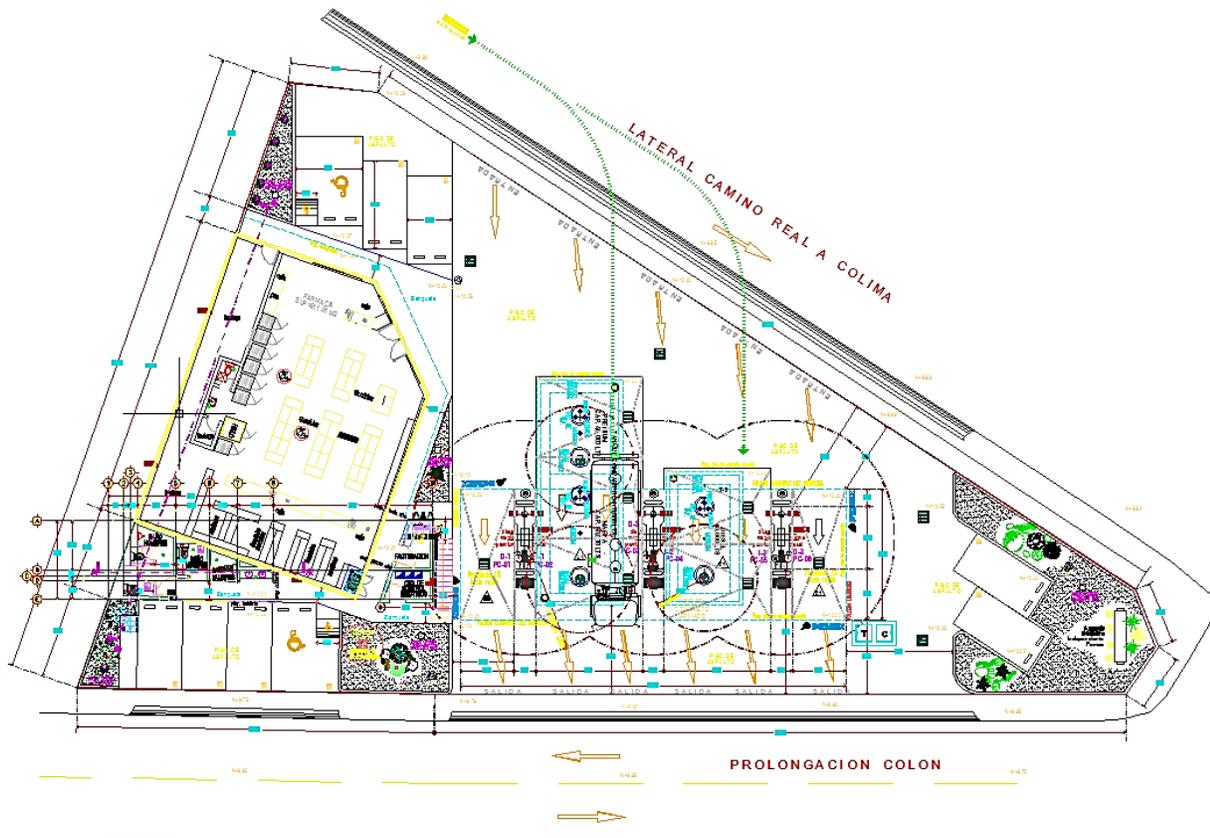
15. Planta de conjunto (A-1) de los planos arquitectónicos del proyecto.
